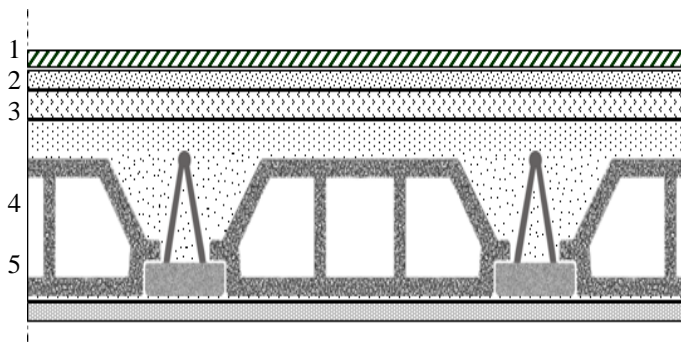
Coupe verticale du plancher courant à corps creux.
